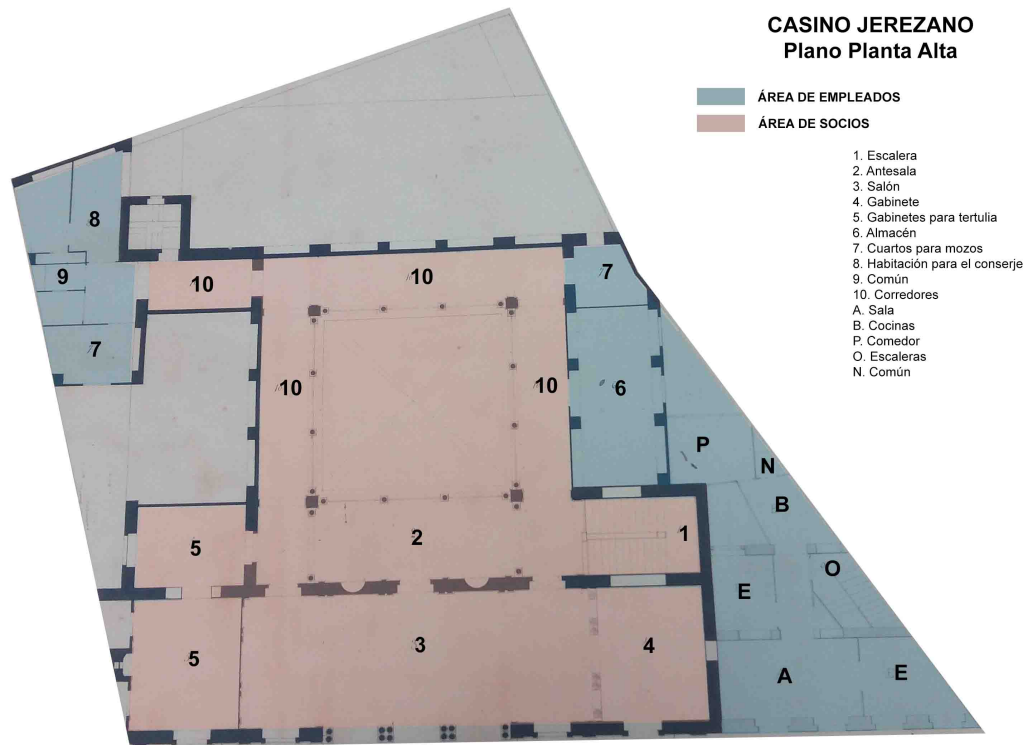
Plano de la planta alta del Casino Jerezano. Fuente: Elaboración propia en base a plano del AFGB.
